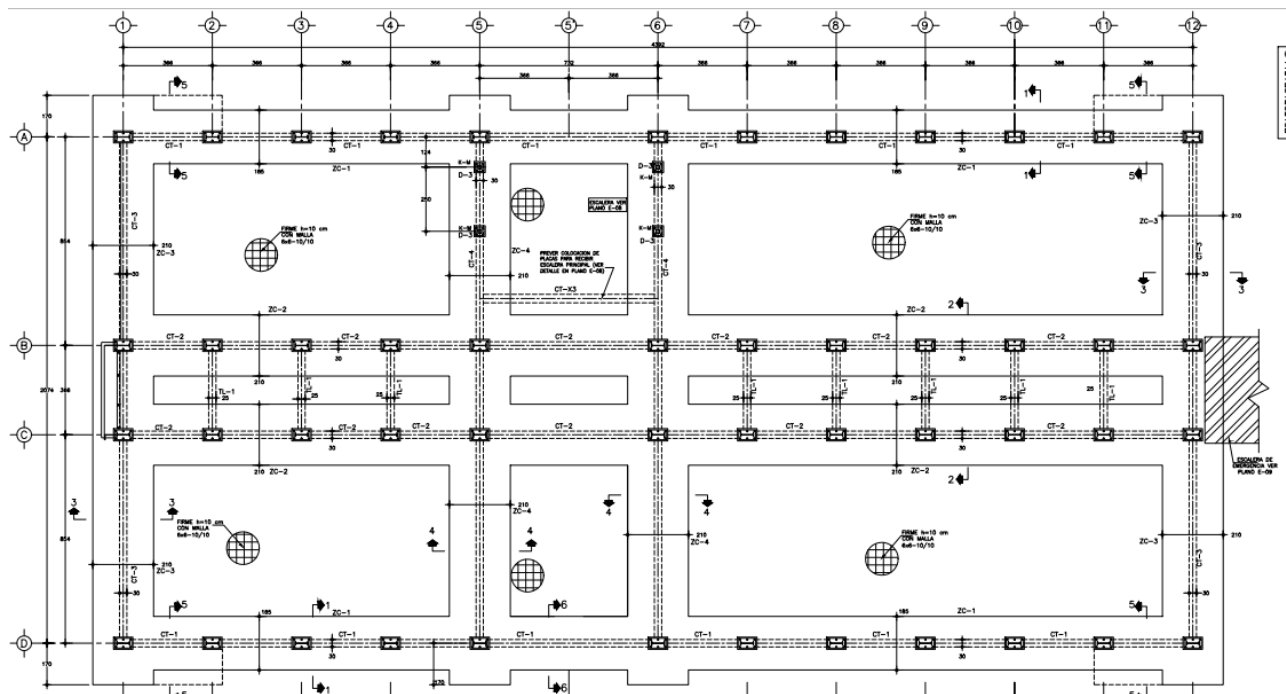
Planta estructural de cimentación. Elaborada por el autor
